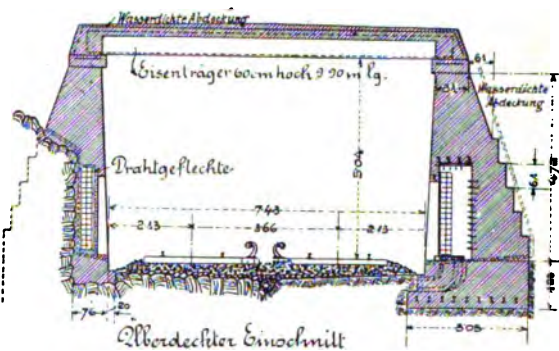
Gedeckter Einschnitt beim St. Marry's Park Tunnel.
